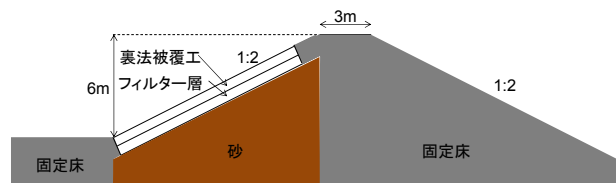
堤防模型の断面図 (寸法は現地換算値)
